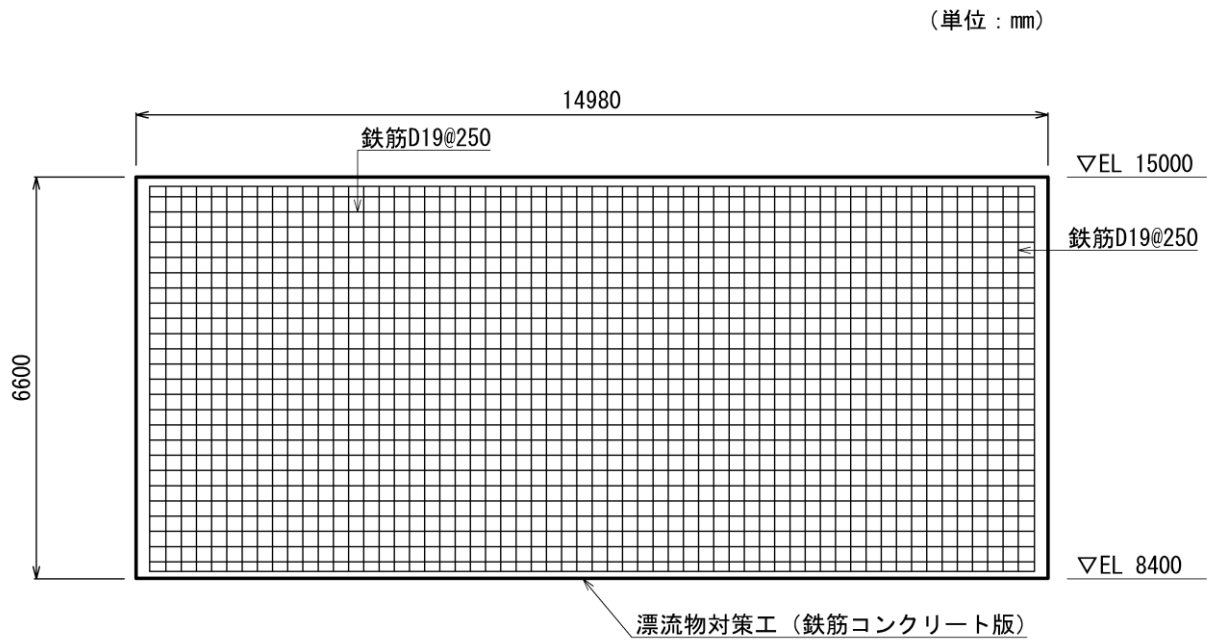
(1) 漂流物対策工 (鉄筋コンクリート版) の概略配筋図 (正面図)
